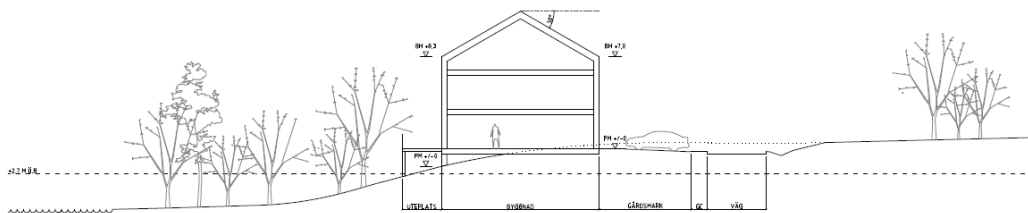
Förslag på bebyggelse. Ena förslaget plattgrundläggs och det andra på plint/pålning.
